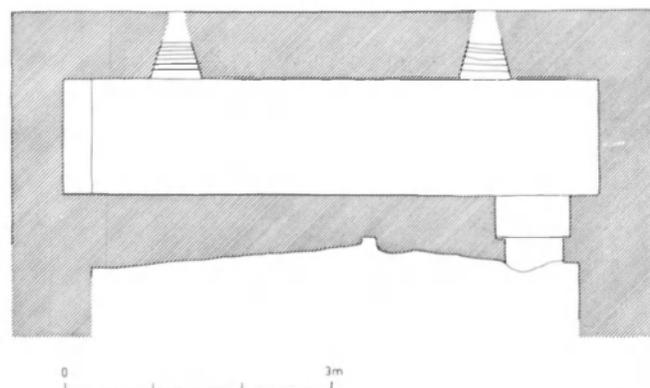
Haringe, église Saint-Martin. Plan terrier de la crypte d'après les fouilles.
